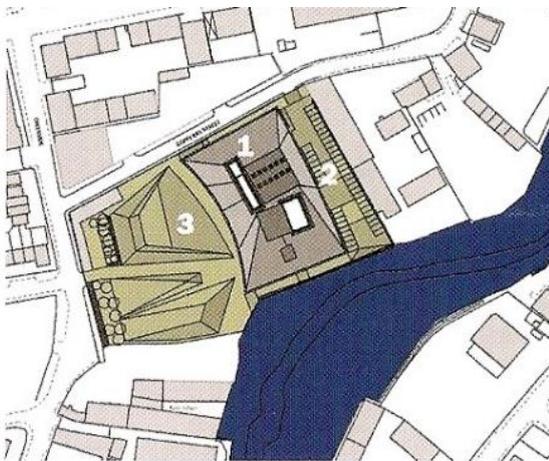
PLANTA DE SITUAÇÃO
